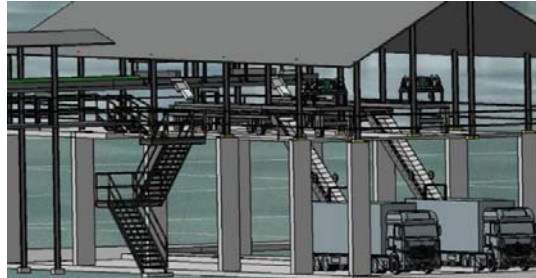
Zona de încărcare a camioanelor (soluția constructivă) [6]
